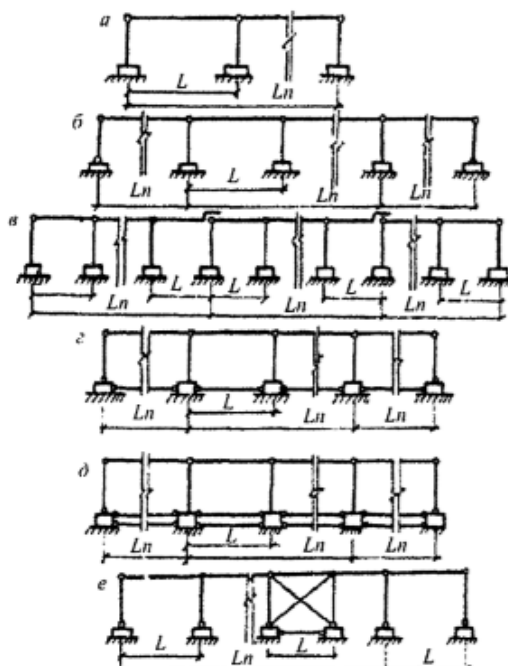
Схемы поперечных рам одноэтажных каркасных зданий
